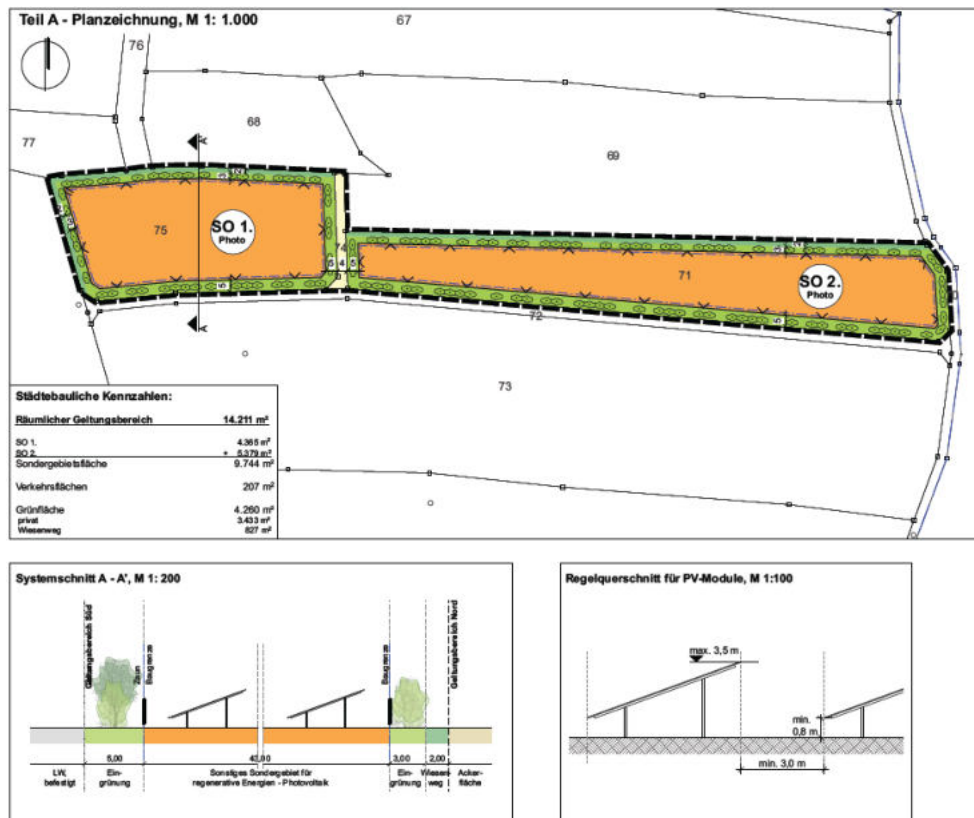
Ausschnitt Planzeichnung B-Plan „Solarpark Bergendorf Schaff“
